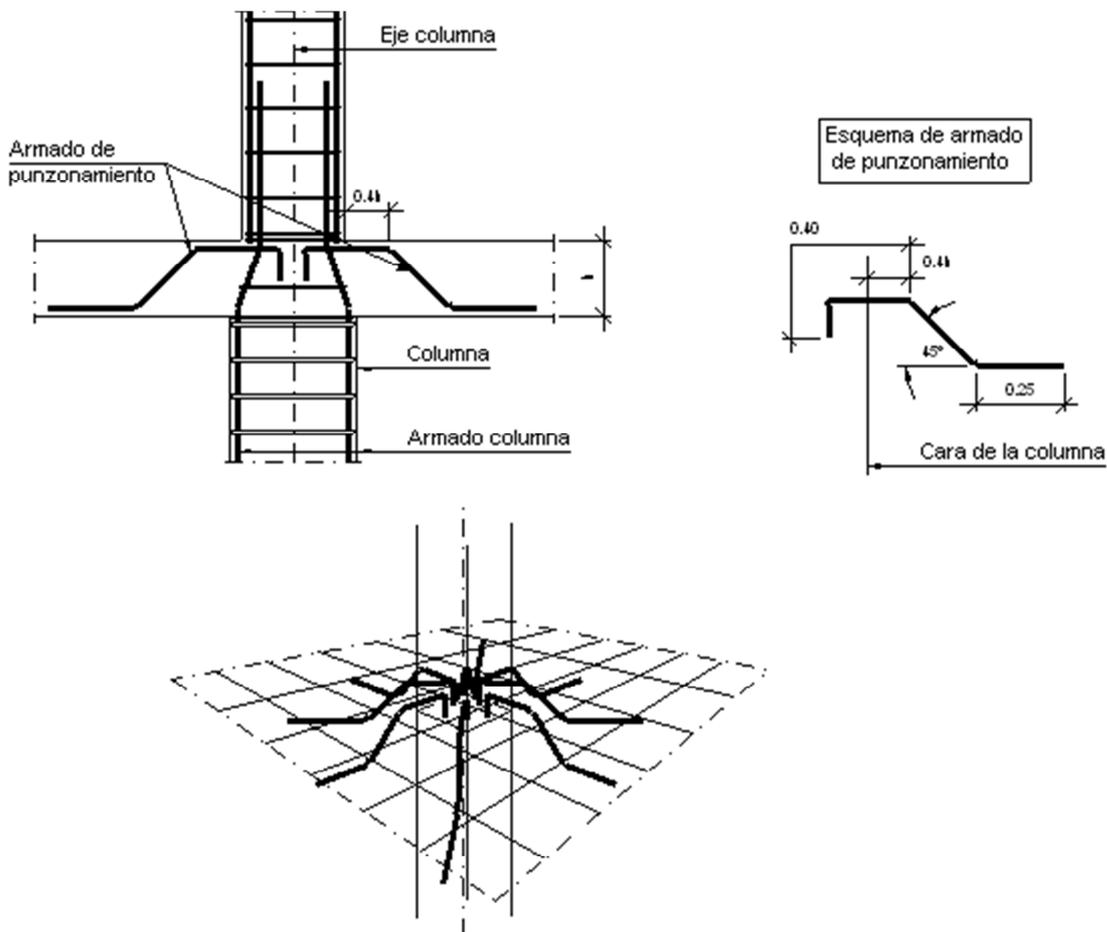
Disposición de la armadura de punzonamiento en pilares centrales
